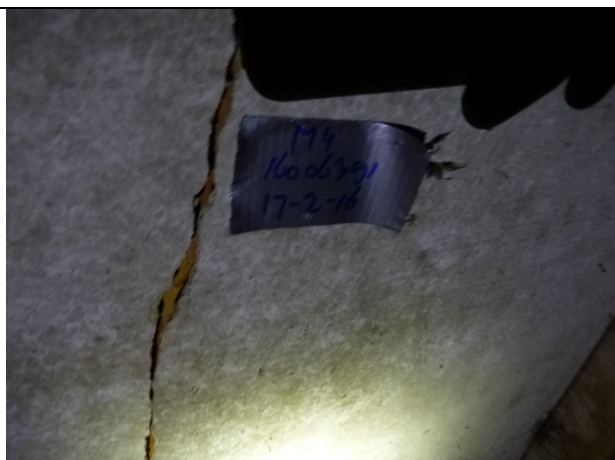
dakbeschot huisnummer 116 is aan buitenzijde afgetimmerd met houten platen.
